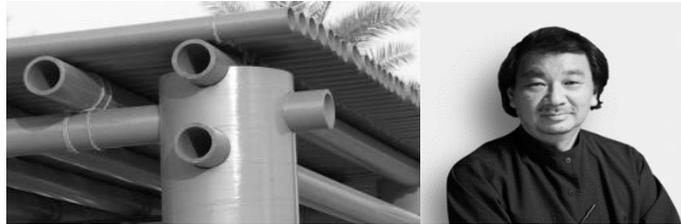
Detalle constructivo de estructura tubular de cartón / Arq. Shigeru Ban. Fuente: www.archdaily.com.
